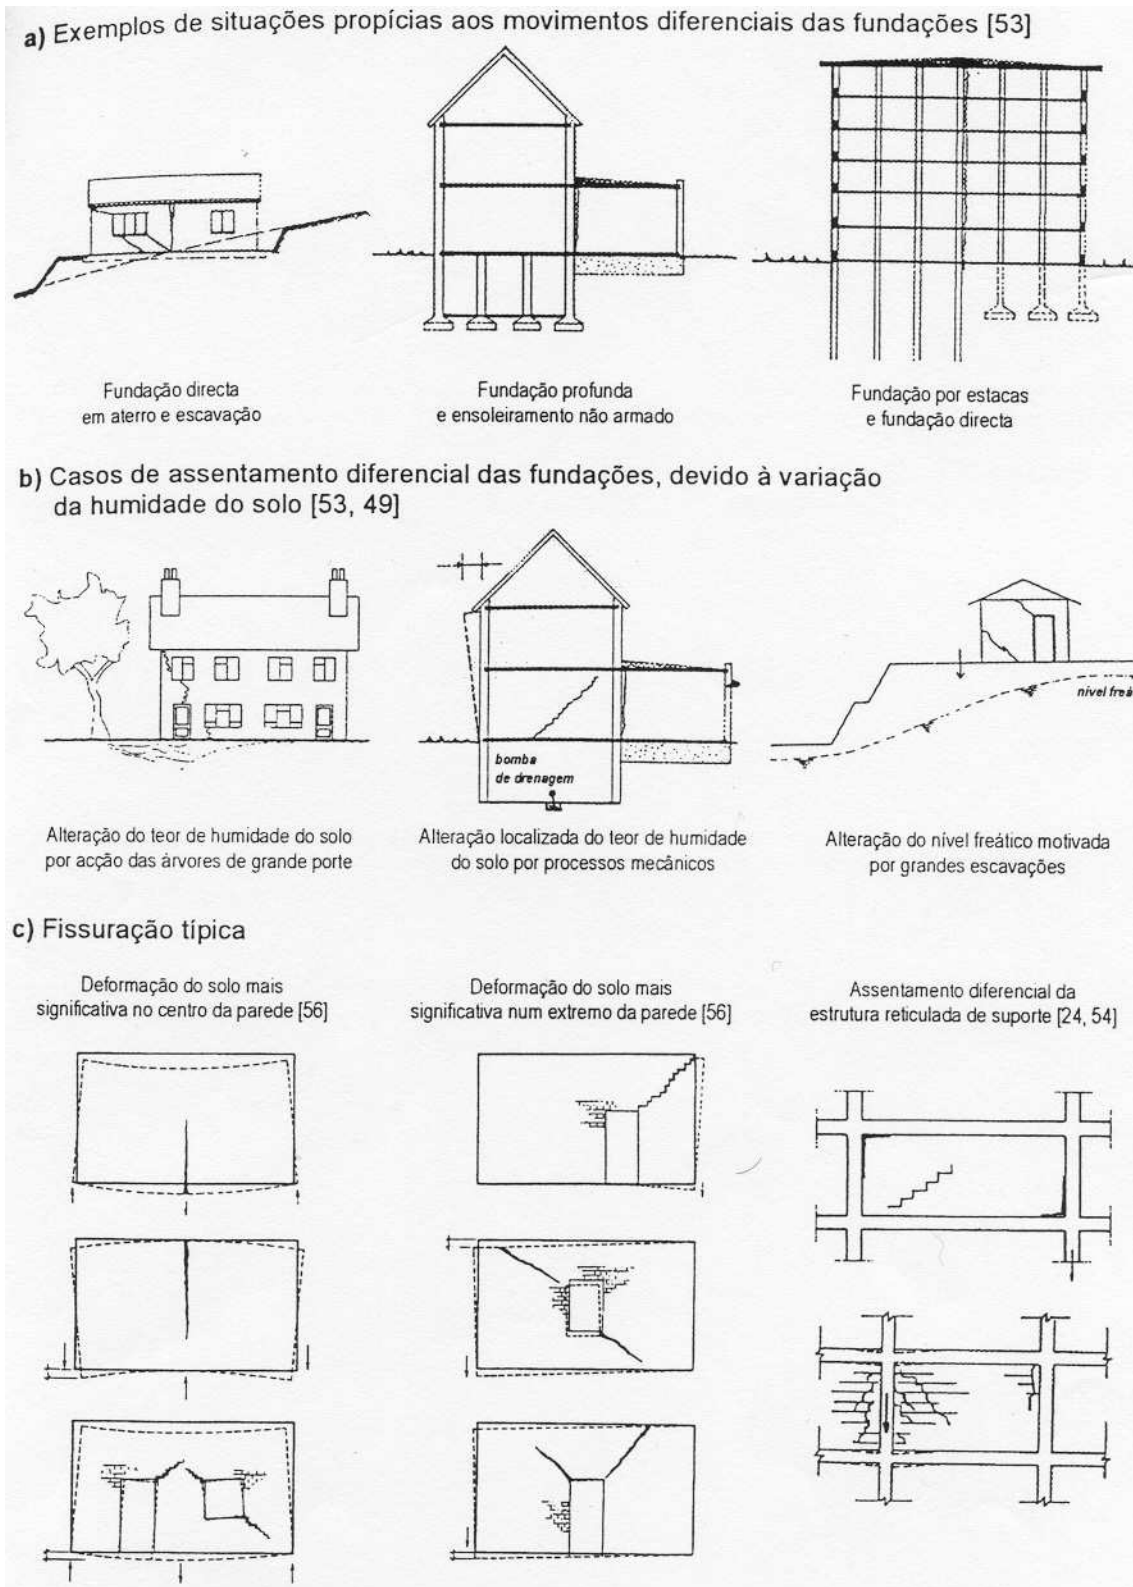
Exemplos de fissuração devida a movimentos da fundação [5]
